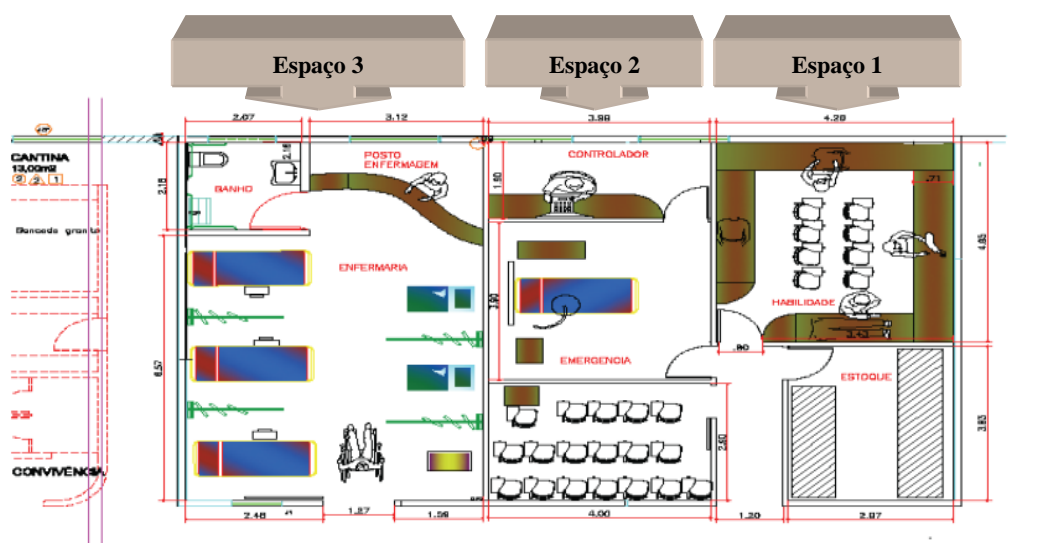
Desenho da planta do Laboratório SIMENF-Saúde da UFPI. Teresina, PI
